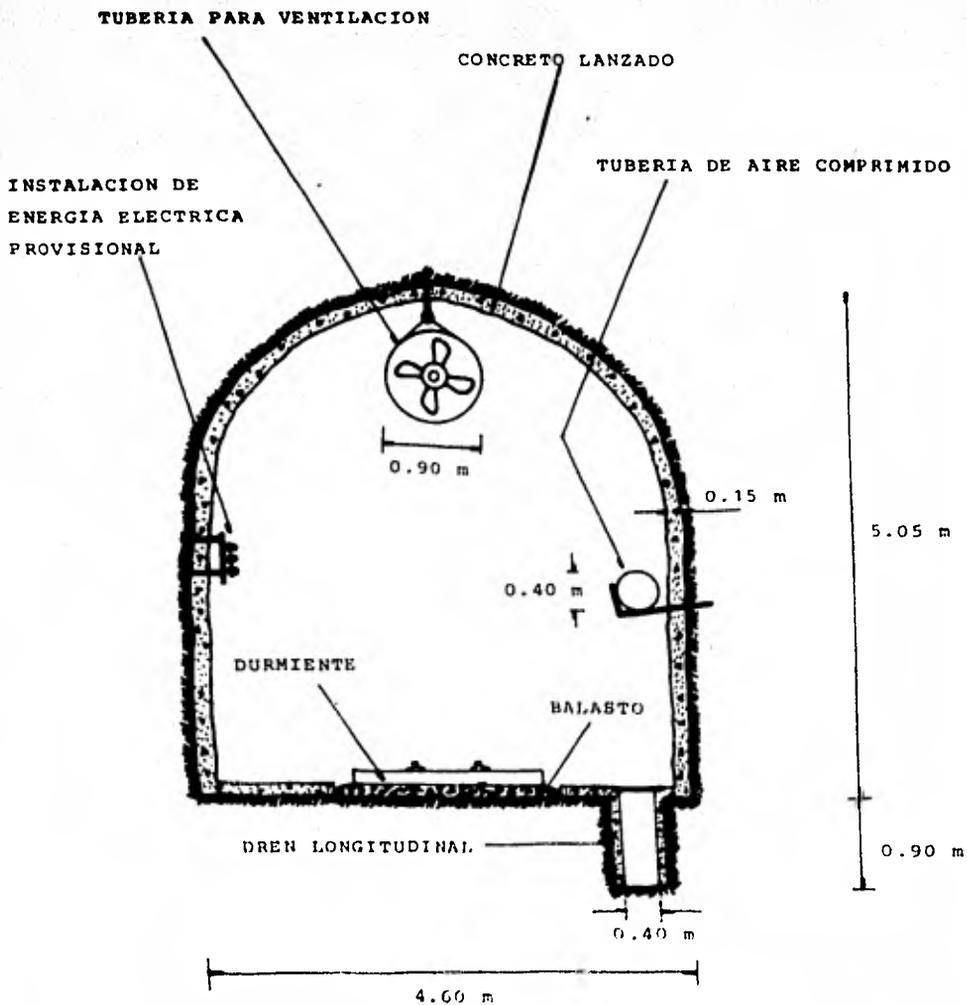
Sección del túnel en zona de terrenos rocosos fracturados o semejantes, la cual se ha adema do con concreto lanzado. No es adecuado usar concreto lanzado en arcillas de alta plastici dad y arenas sueltas.
